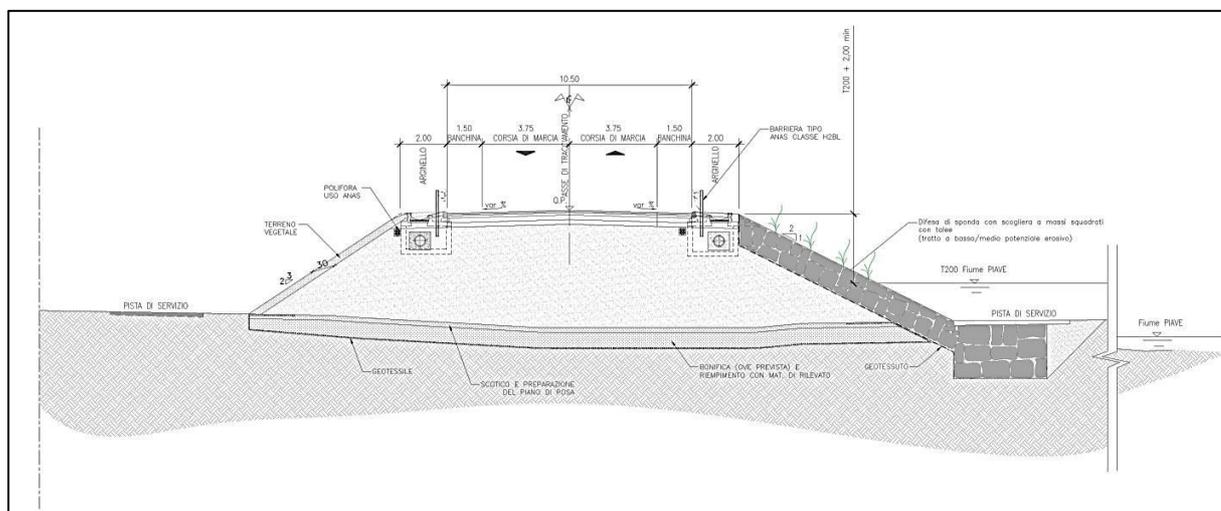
Sezione tipo C1 con difesa spondale a massi tratto a basso/medio potenziale erosivo.
